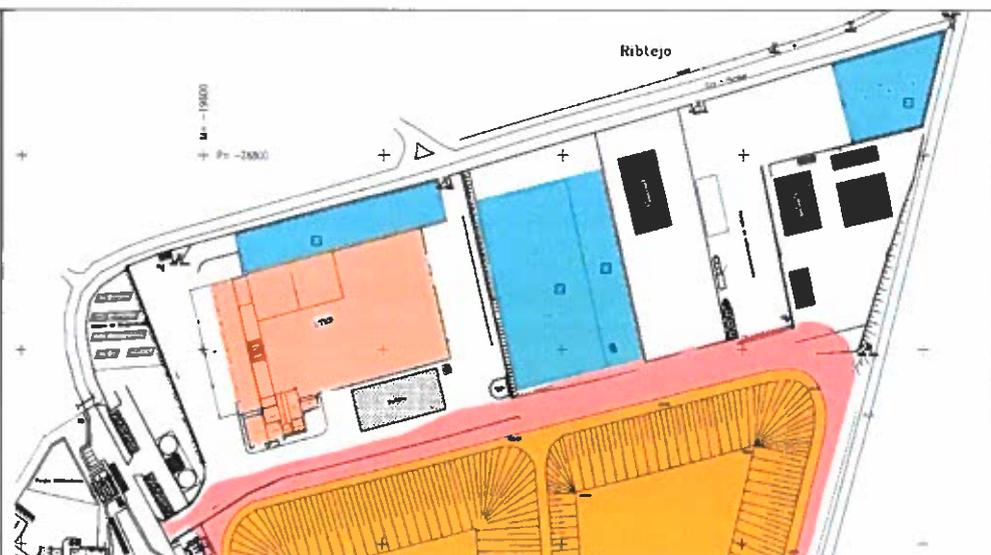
Extrato Des.nº10 UTMB e célula 2 – planta da situação futura, março 2023 (Fonte: EIA)
